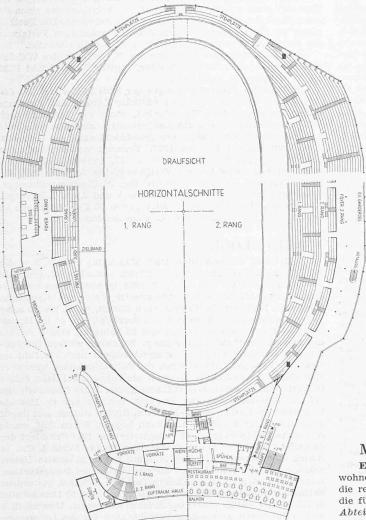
Grundriss vom 1. und 2. Rang mit Draufsicht. — 1:1000
